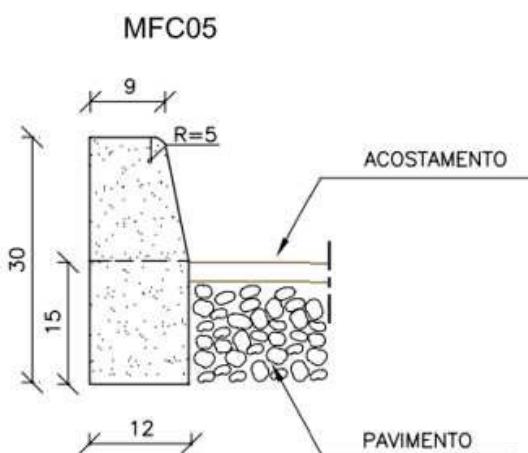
Seção transversal do meio-fio do tipo MFC05 (medidas em cm)
